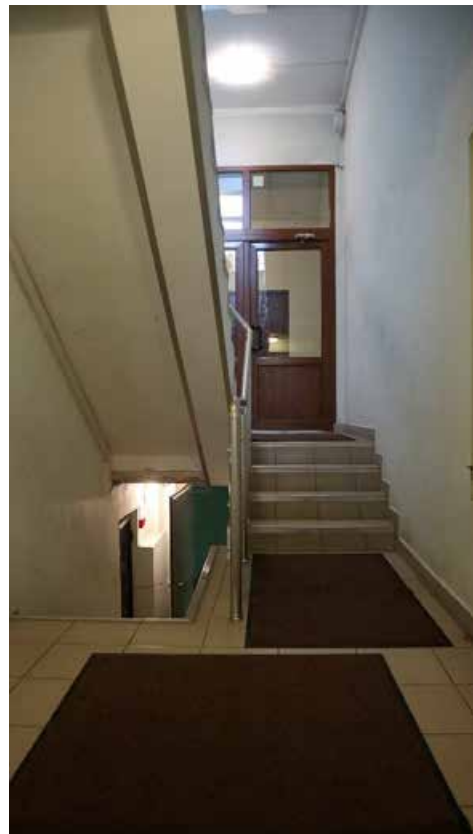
1 этаж, лестница в юго-западной части здания, помещение 1-Н (250).
